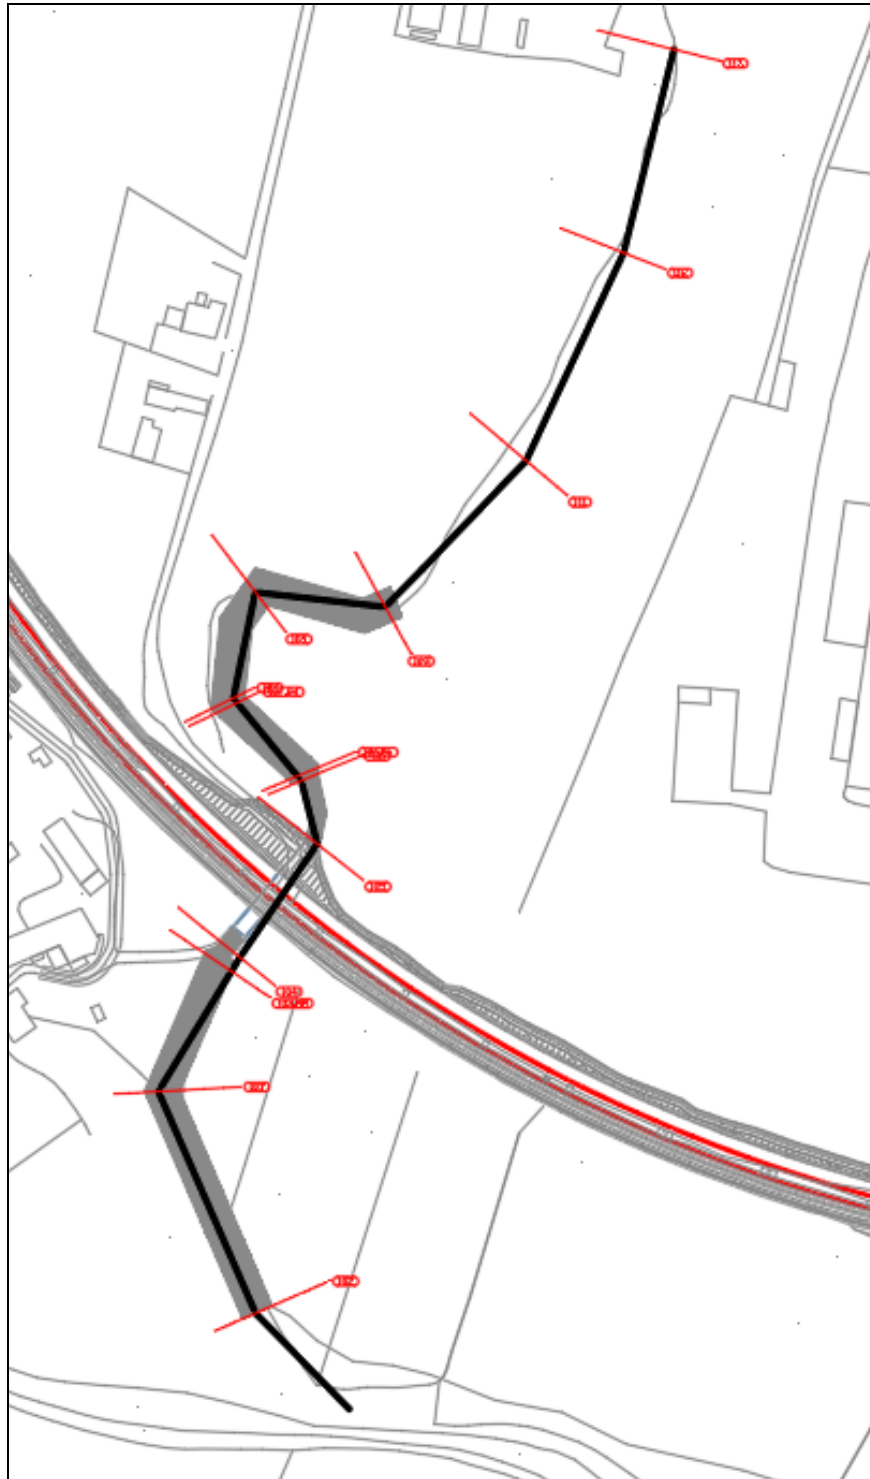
Schema planimetrico dell'asse IN04 in condizioni Post Operam
